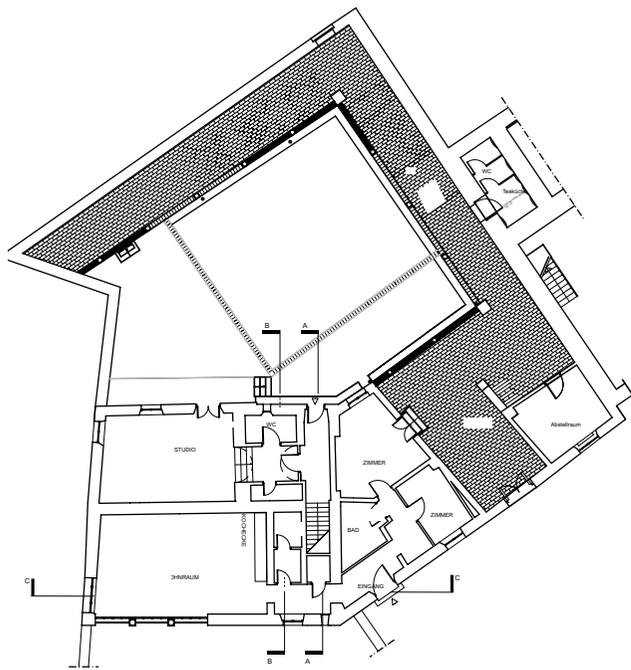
Grundriss Villino EG
